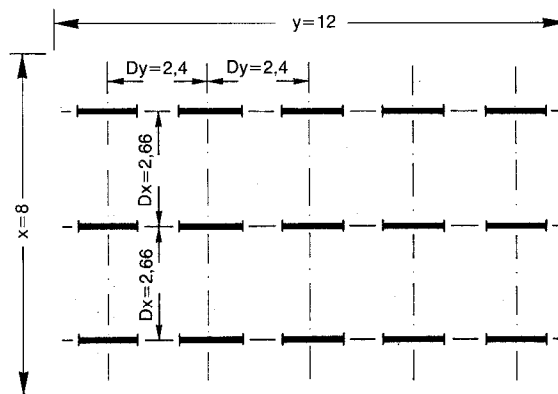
Disposizione degli apparecchi illuminanti.
